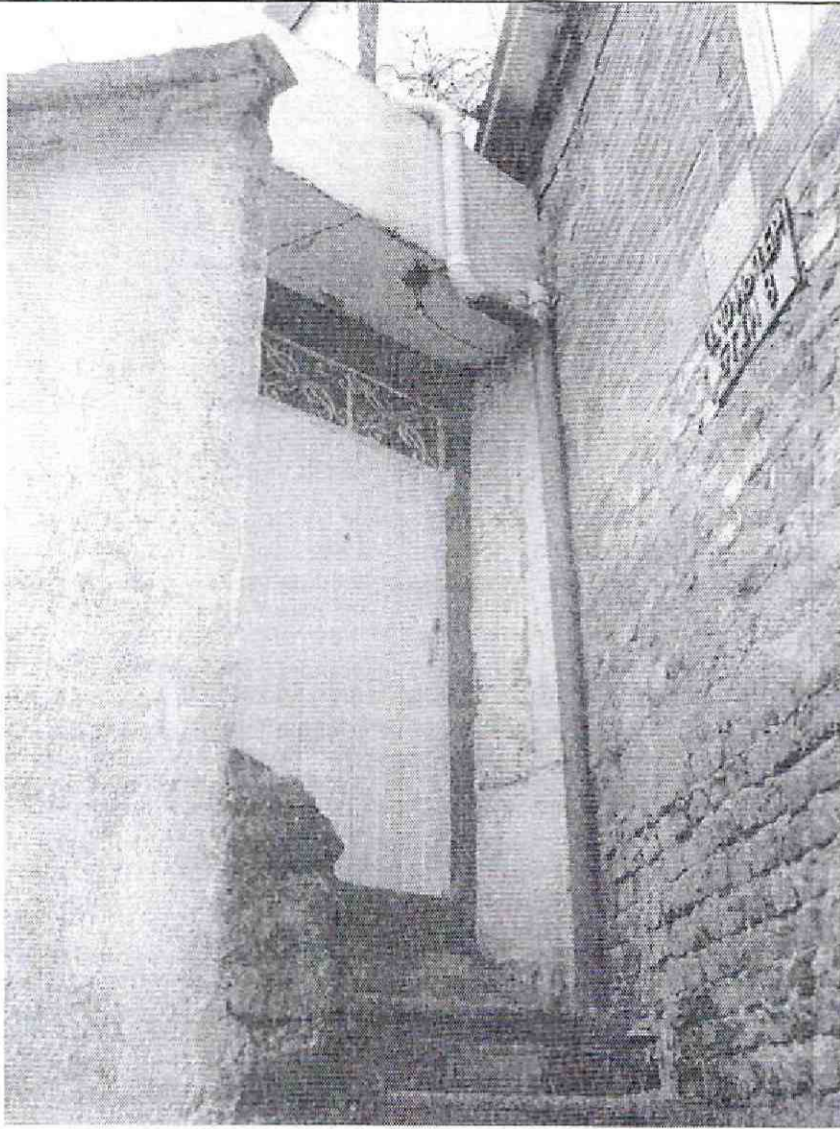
Fachada principal, puerta de ingreso al inmueble. No se observa daños
